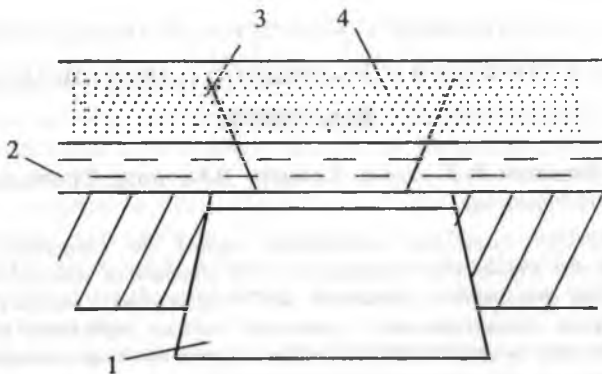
Схема крепления выработки с помощью анкеров, где 1 – выработка; 2 – непосредственная кровля; 3 – анкер; 4 – основная кровля.
